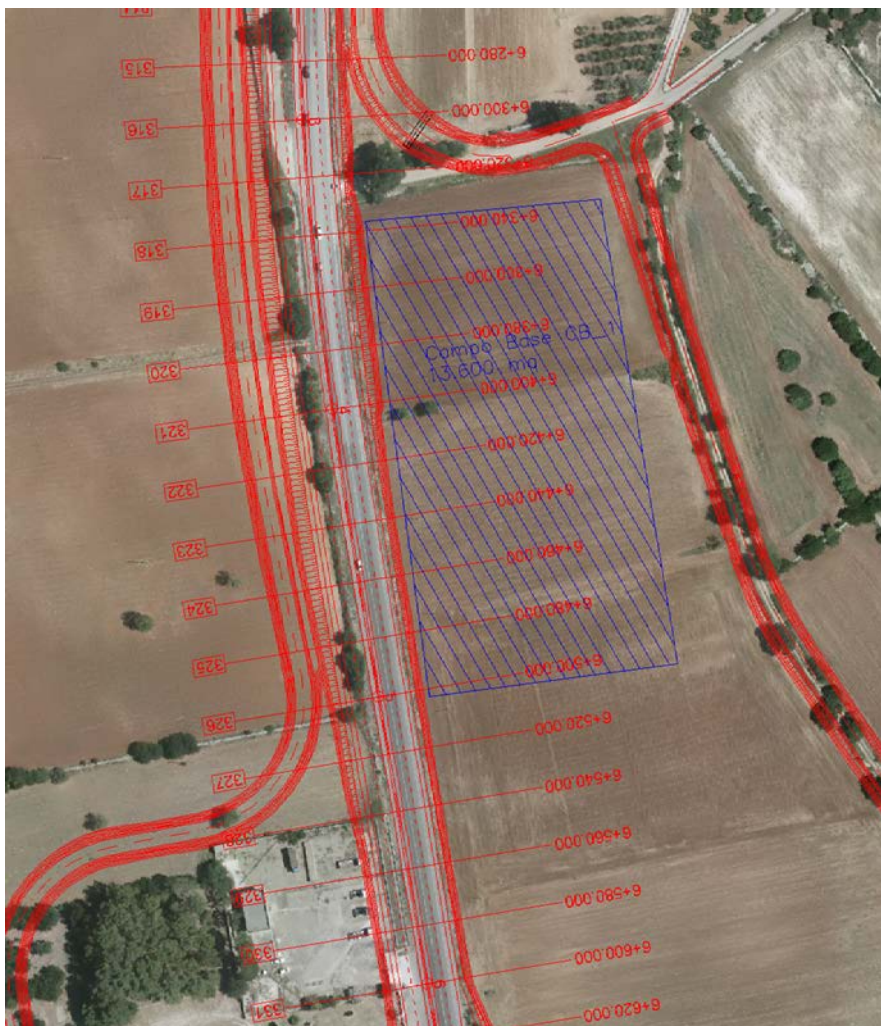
Superficie occupata dal Cantiere Base CB_1
